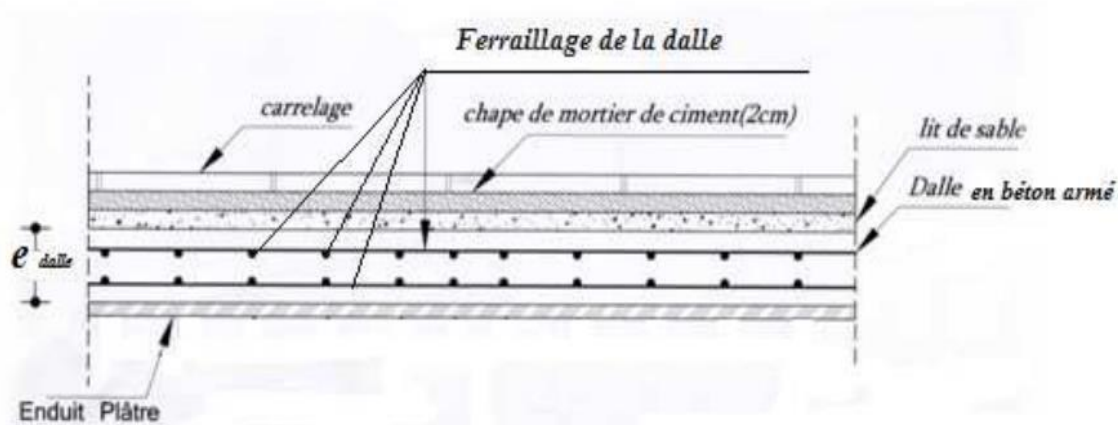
Détails d'un plancher en dalle pleine en béton armé (Plancher étage).
